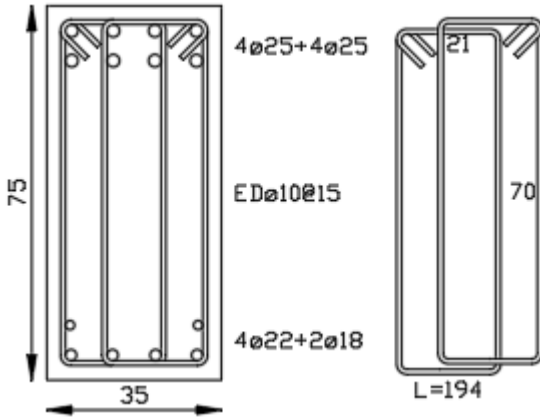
Vigas ejes B y E, nivel 6-15/20. Edificios de 15/20 pisos.
